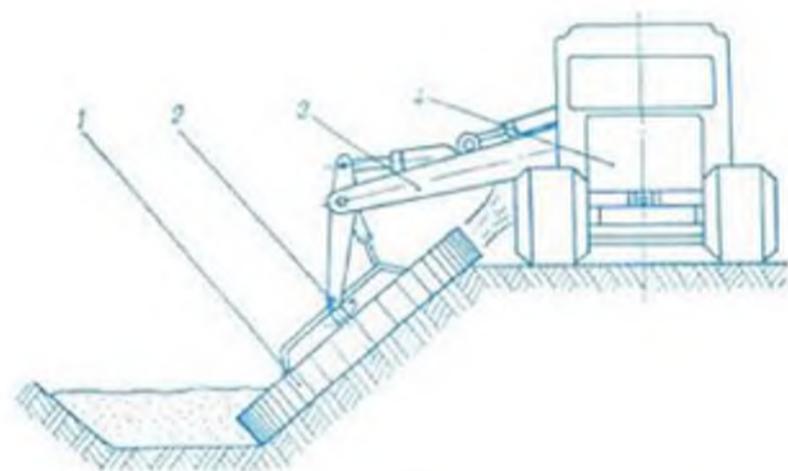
Схема фрезерного каналоочистителя с рабочим органом, вращающимся вокруг оси, перпендикулярной откосу канала: 1 — фреза; 2 — ось её вращения; 3 — стрела; 4 — базовая машина.
